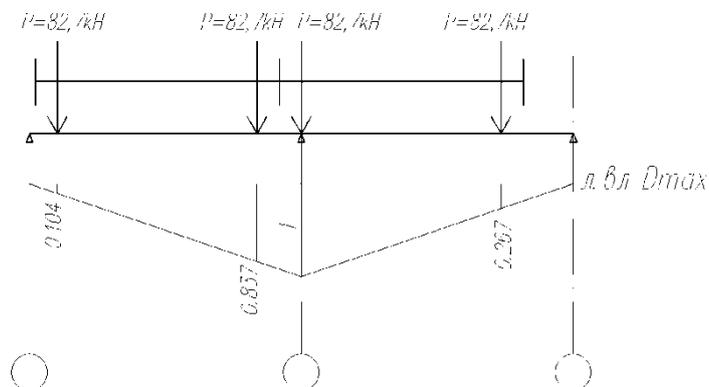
Схема приложения нагрузки от крана 10 т
